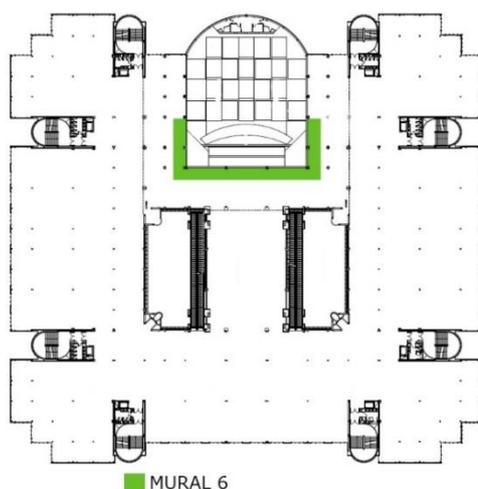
Plano planta 1 donde se indica la ubicación del mural 6..
